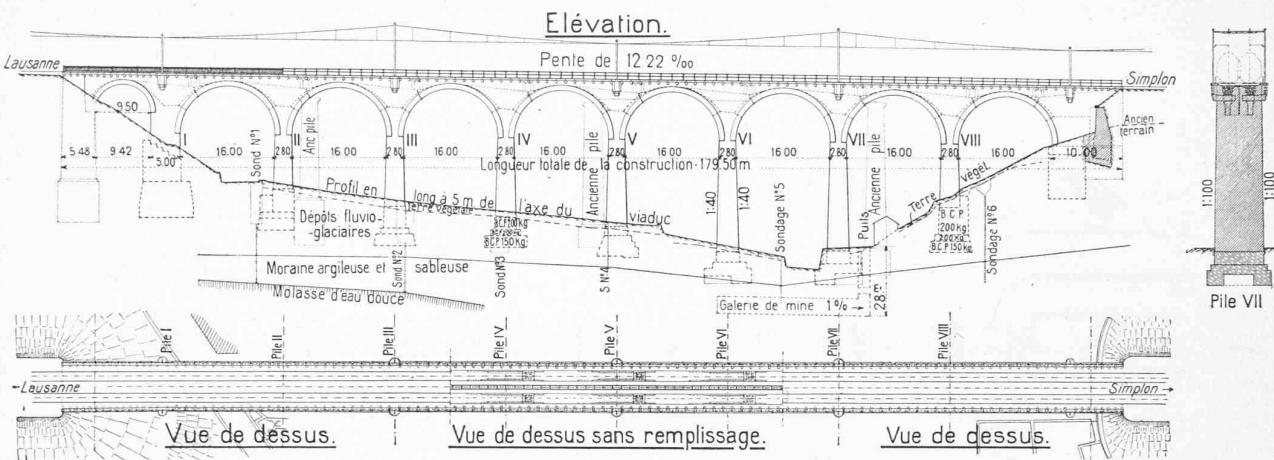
Plans, coupes et élévation du viaduc de la Paudèze.
